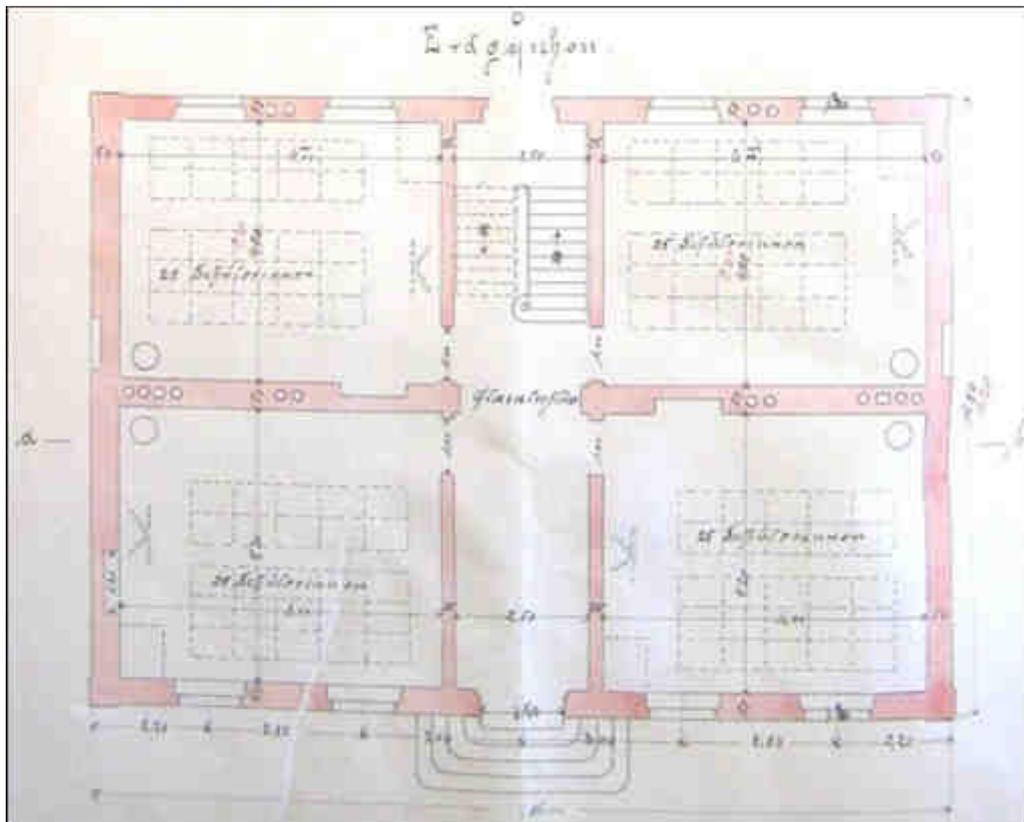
Plan de sol du rez-de-chaussée du bâtiment de l'école subventionnée supérieure de filles de Sarrebourg à construire en 1888 (extrait du projet de l'architecte Bretz, 28.05.1888, ADBR 34AL1459).
